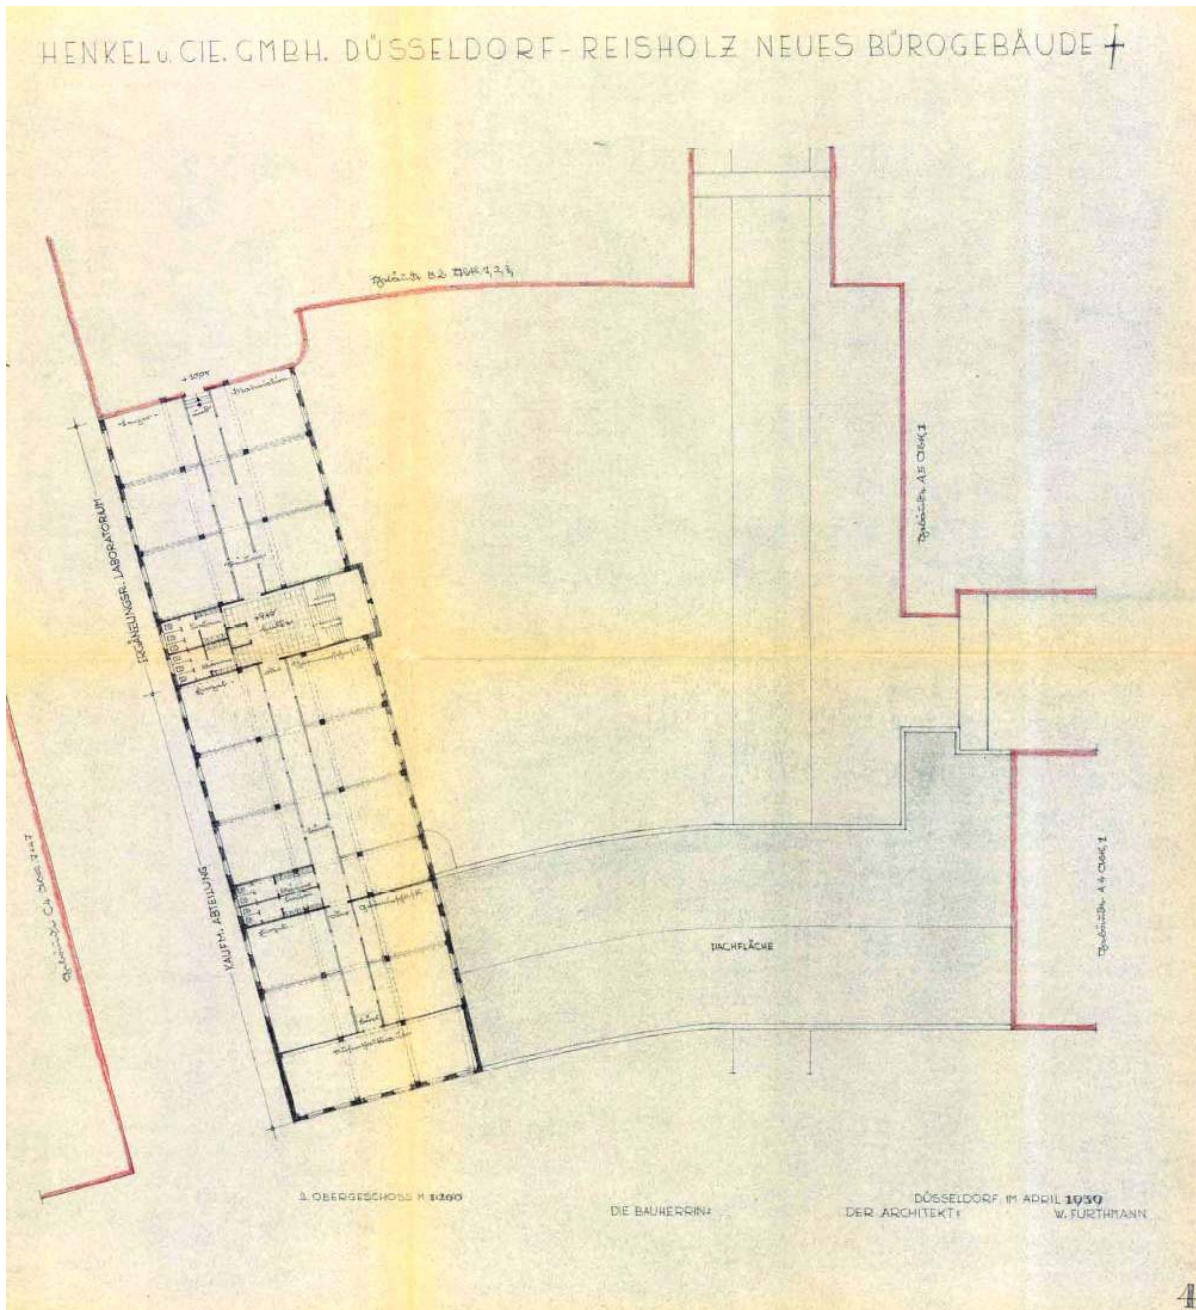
Entwurf zum Bürogebäude, Grundriss-2.Obergeschoss, April 1939 – Arch.: W. Furthmann
